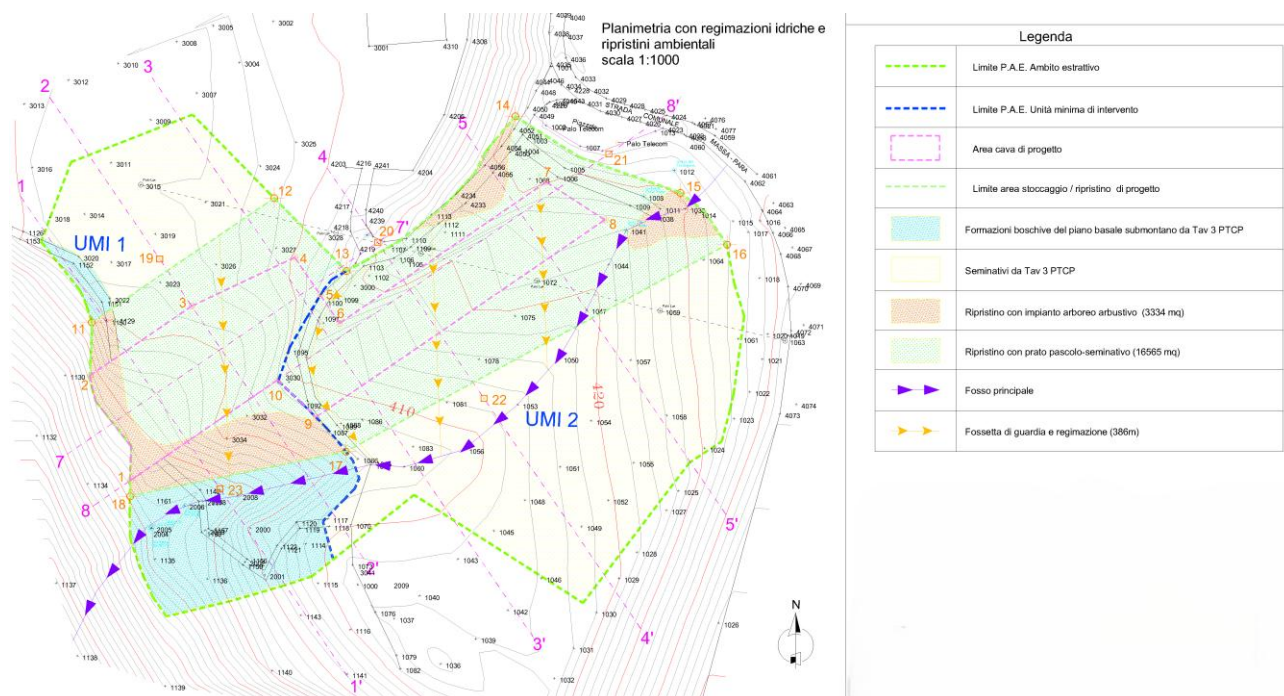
Planimetria estratta dalla Tav. 10' – Planimetria ripristino con inclusione zona soggetta a richiesta in deroga (elaborata dal Dott. Geologo Massimo Mosconi).
